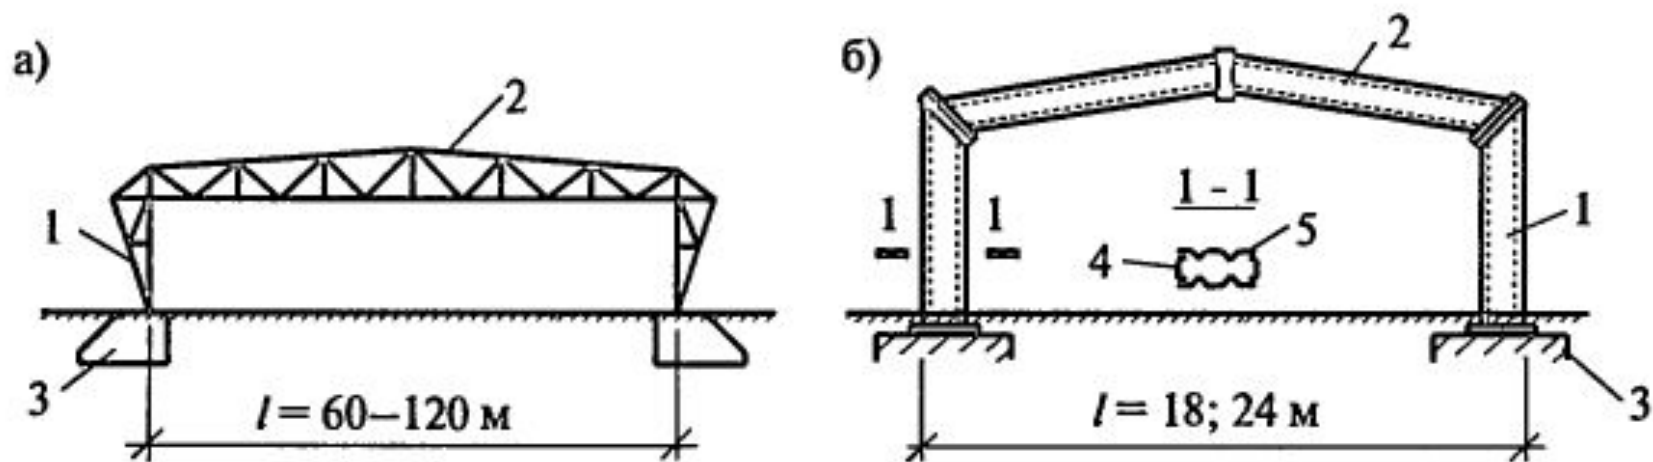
Стальные рамы: а) сквозная стальная рама; б) легкая стальная рама; 1 — стойка; 2 — ригель; 3 — фундамент; 4 — швеллер; 5 — гофрированная стенка (лист $t = 4 \text{ мм}$)
